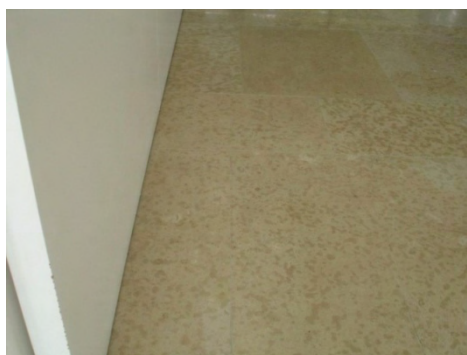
Pormenor do pavimento em pedra de vidro
